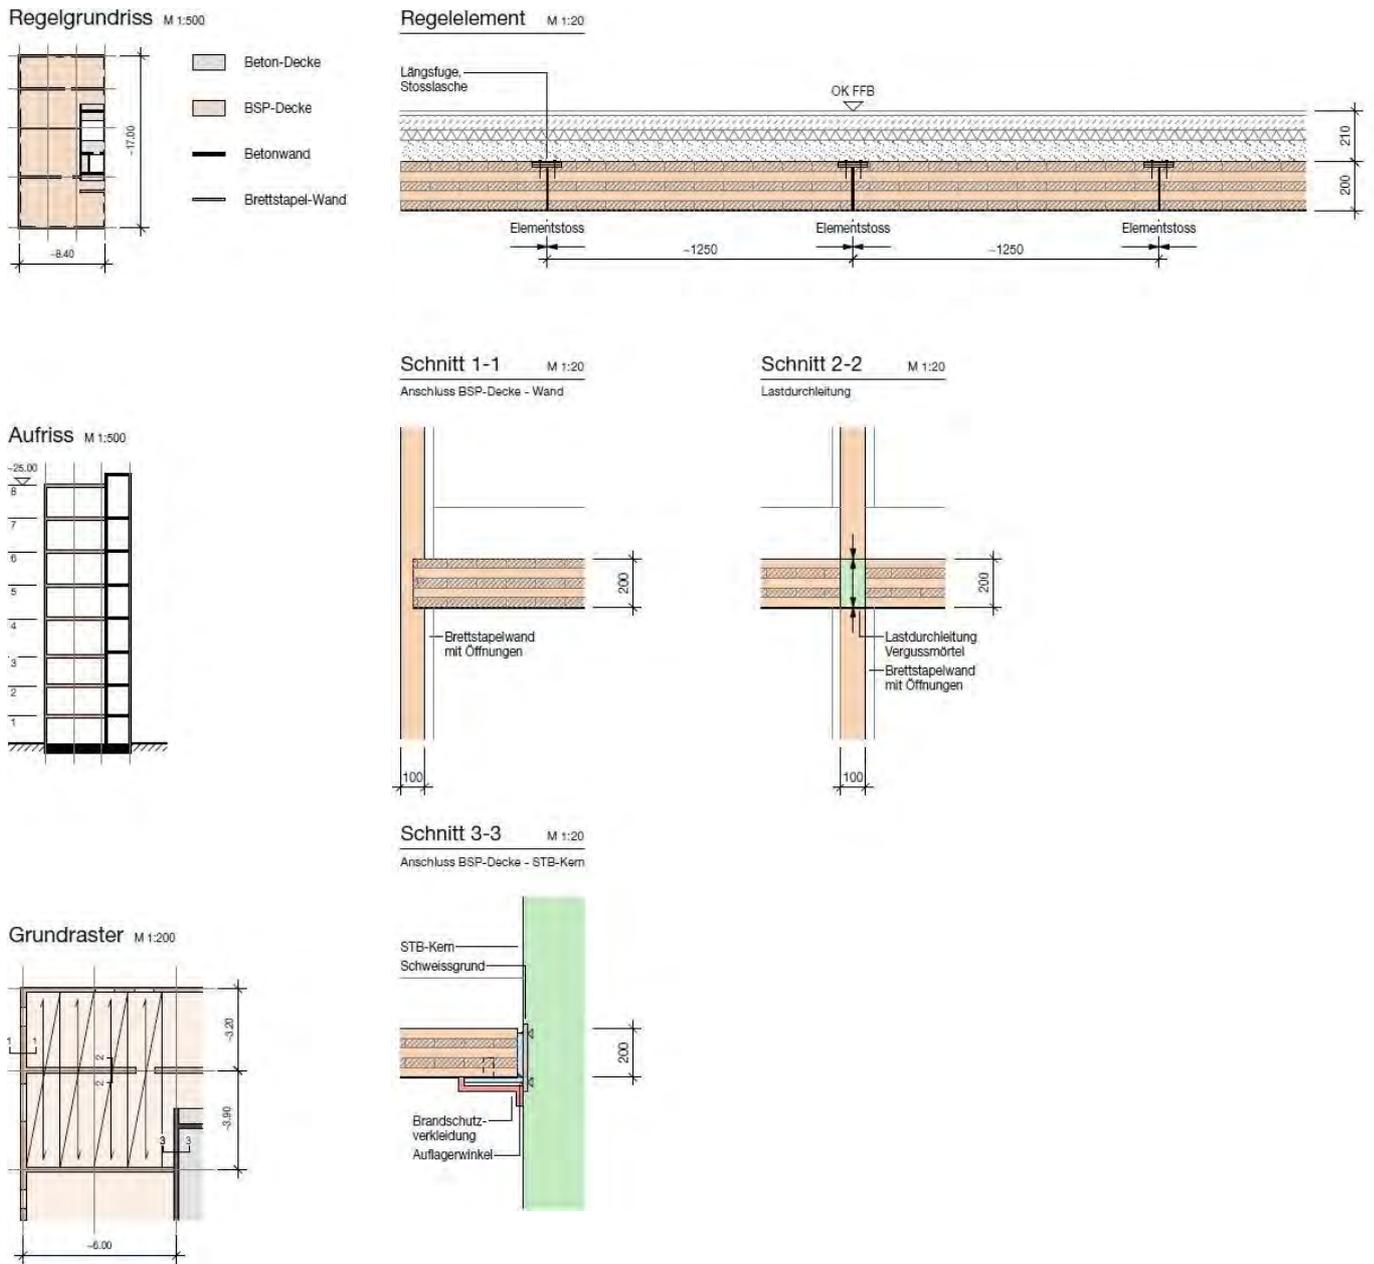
Konstruktionsdarstellung, Holz 8, Bad Aibling
